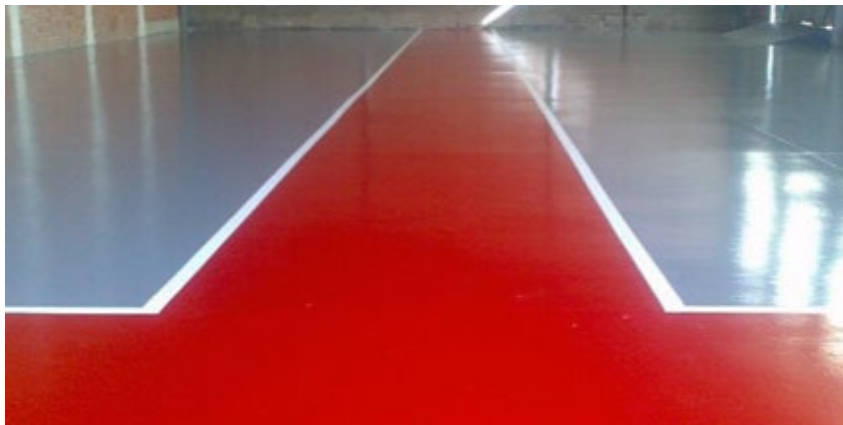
Exemple d'aplicació de la pintura Paviment Multicapa
